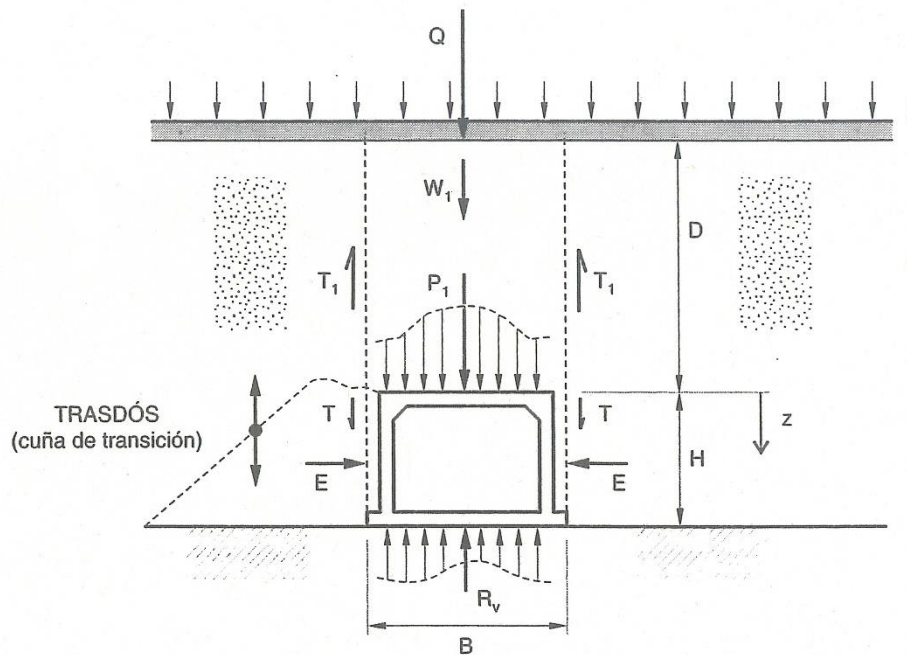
Esquema de acciones en una obra enterrada. Fuente: Adaptado de Guía de cimentaciones en obras de carretera. Ministerio de Fomento, 2003.
